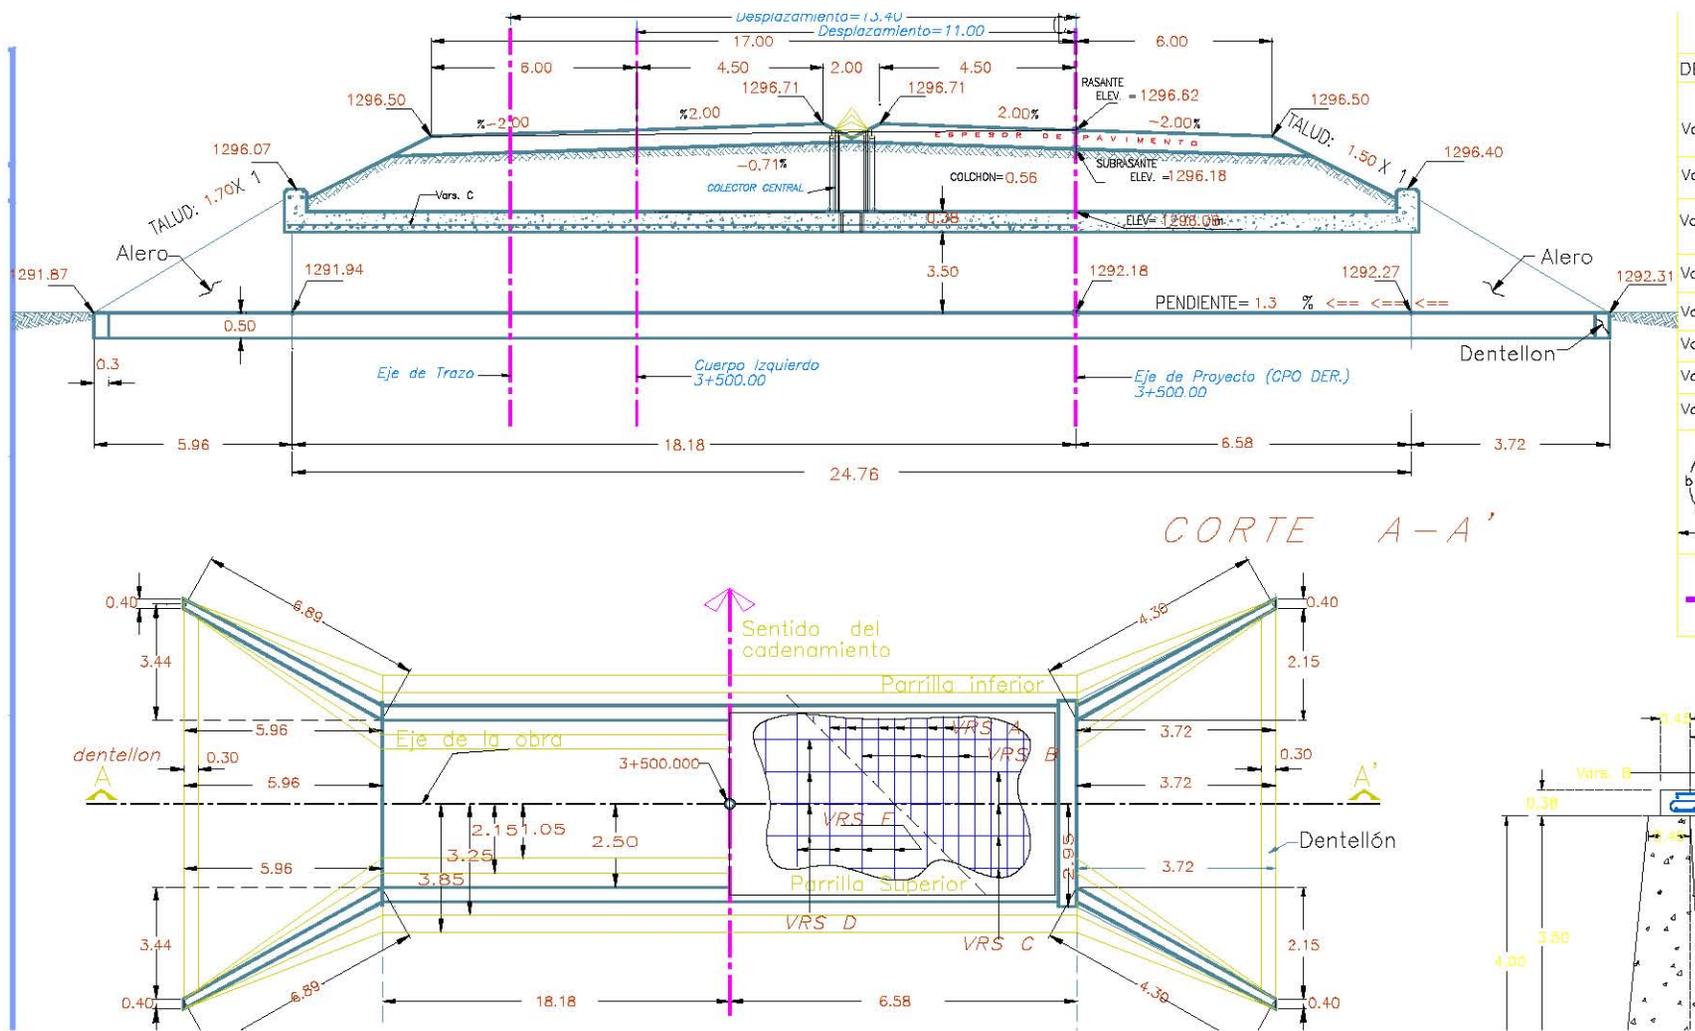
Parte del plano de proyecto de la obra de drenaje a verificar en el km 3+500.00
